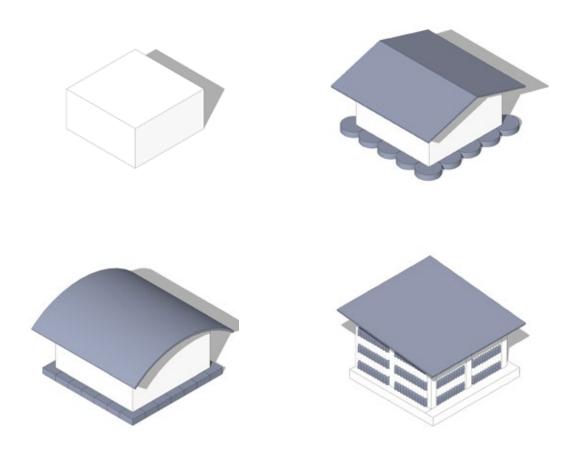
Materiales Reciclados del sistema Constructivo FUENTE: Autoría propia.
